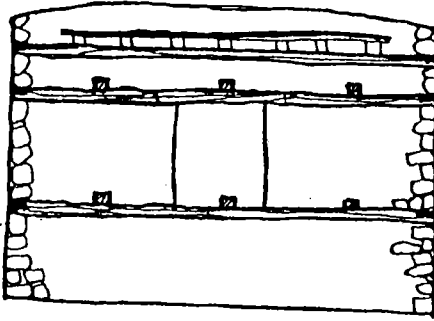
Hatılsız Deney Yapısının Plan ve Kesitleri
